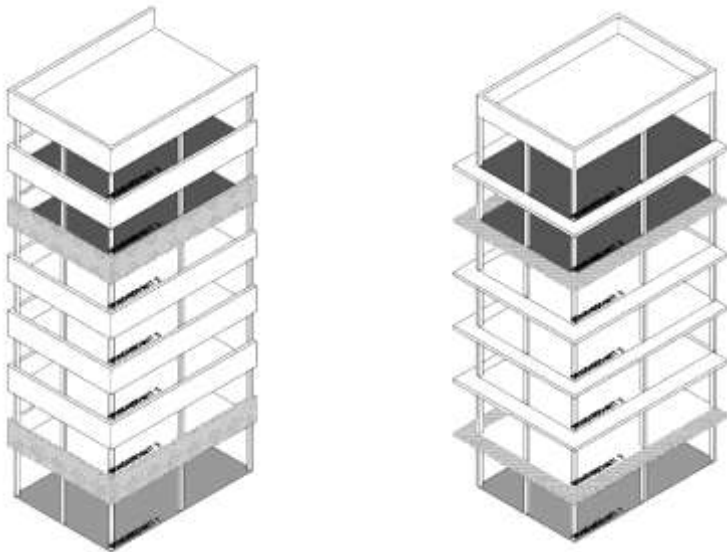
(li.): Schemadarstellung Fensterbandfassade mit Brüstung [<https://www.wien.gv.at/wohnen/baupolizei>, 08.10.2017]
